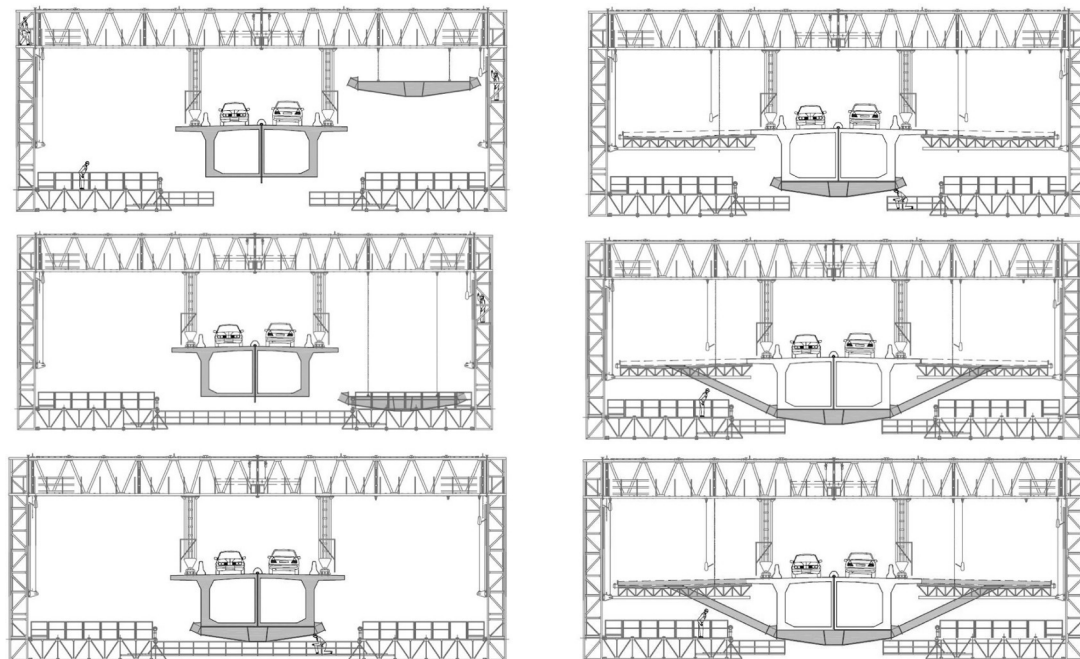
Cimbra móvil para la instalación de jabalcones y hormigonado de la losa ampliada.
